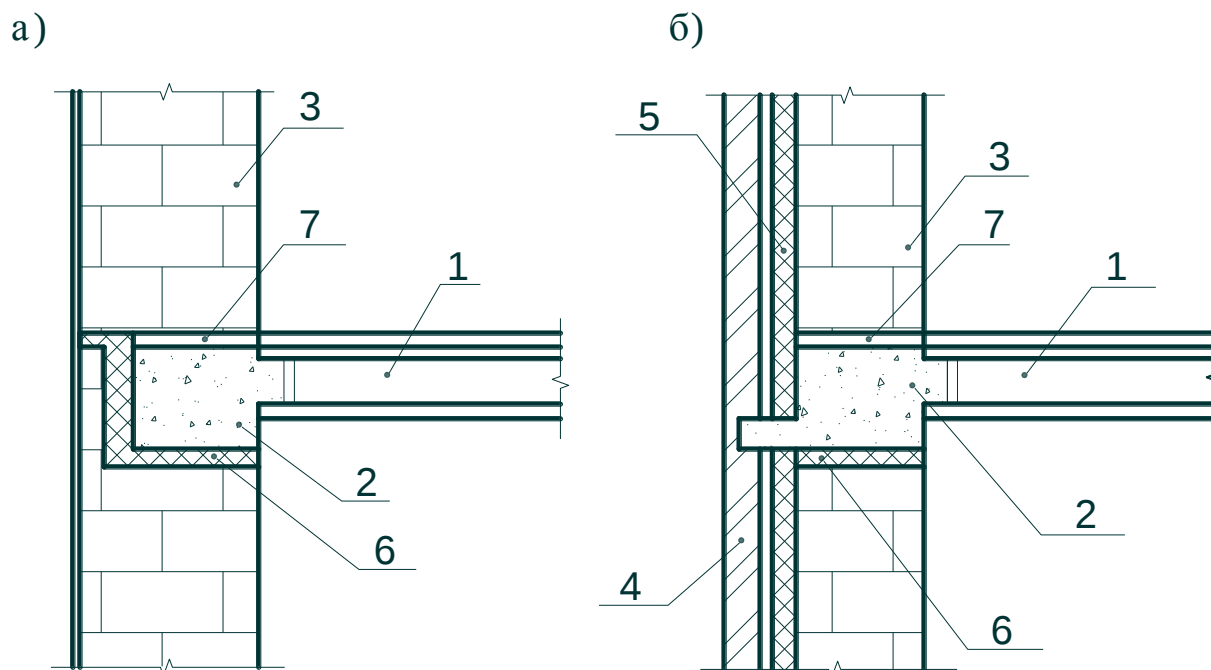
Узлы сопряжения наружных стен с дисками перекрытий
